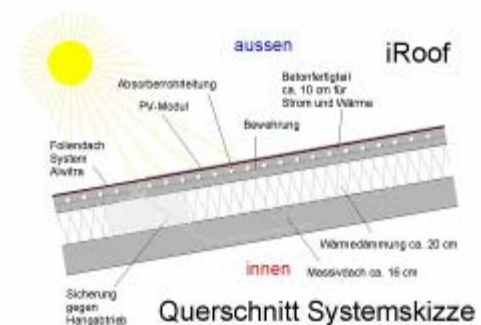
Systemskizze „iRoof“ Dachaufbau
